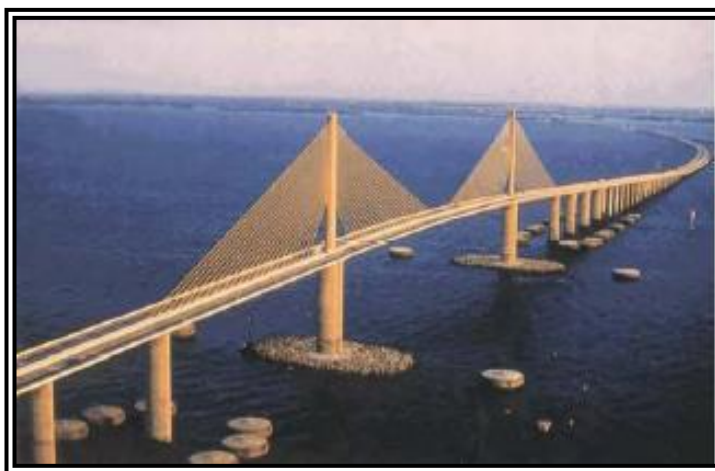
Puente atirantado con plano único de atirantamiento⁴³
